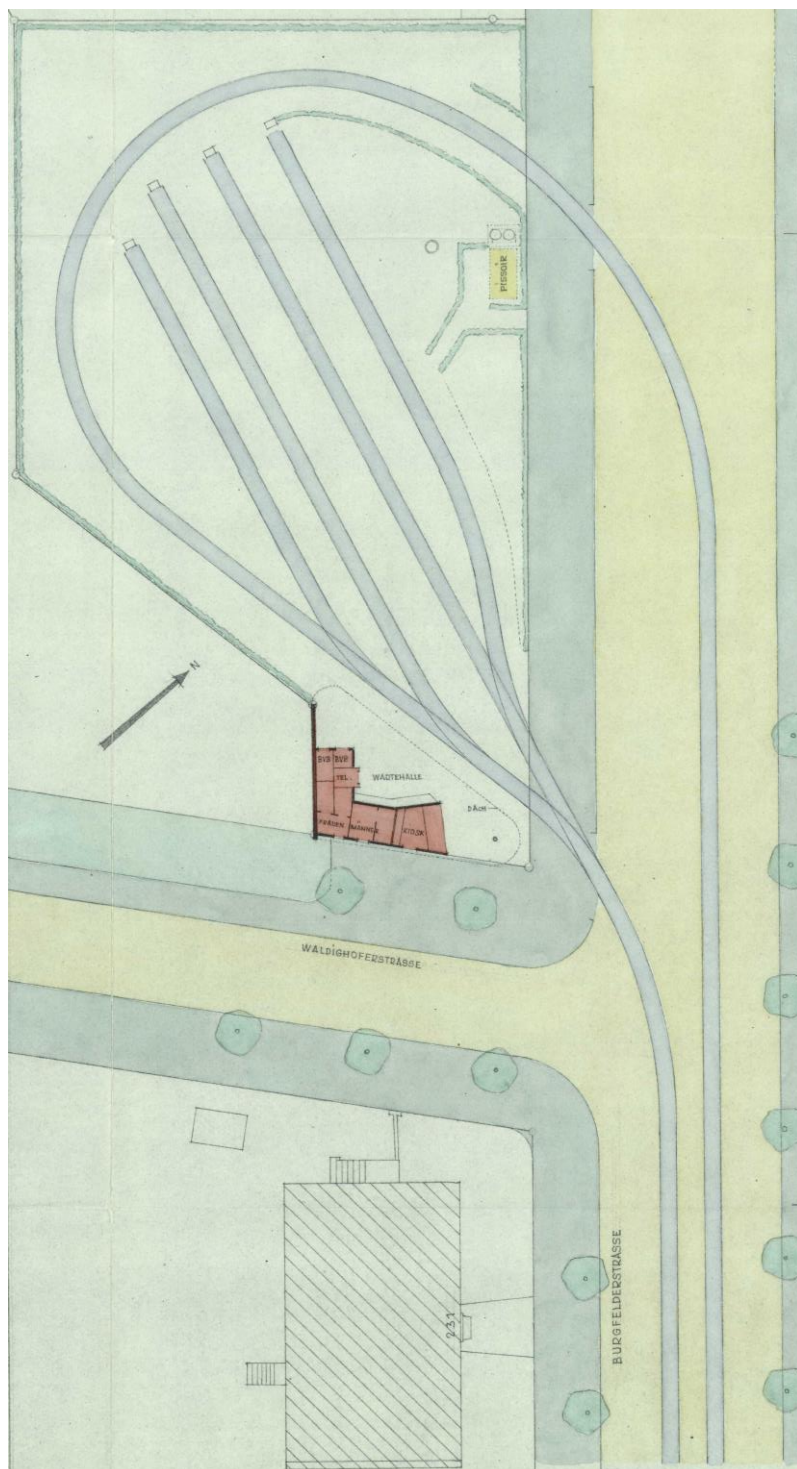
Situationsplan 1959 (Massstab 1:200)
